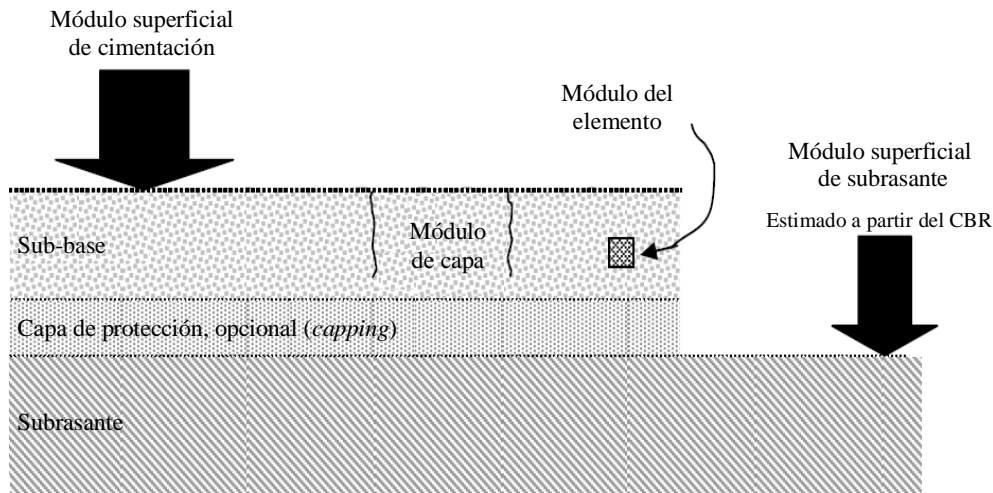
Estructura de la cimentación de la losa de concreto
